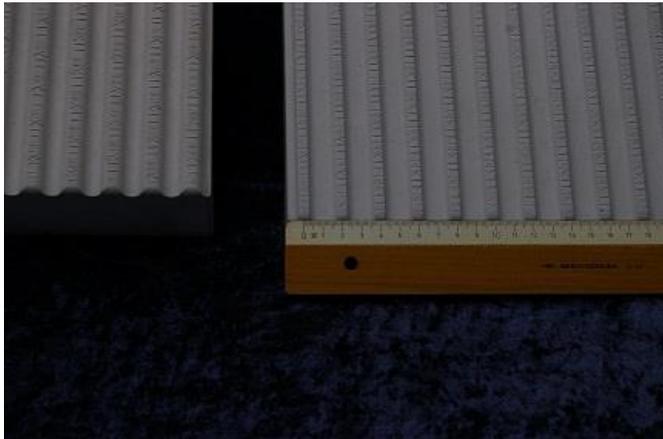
Bodenindikatoren mit 20 mm Rillenabstand
